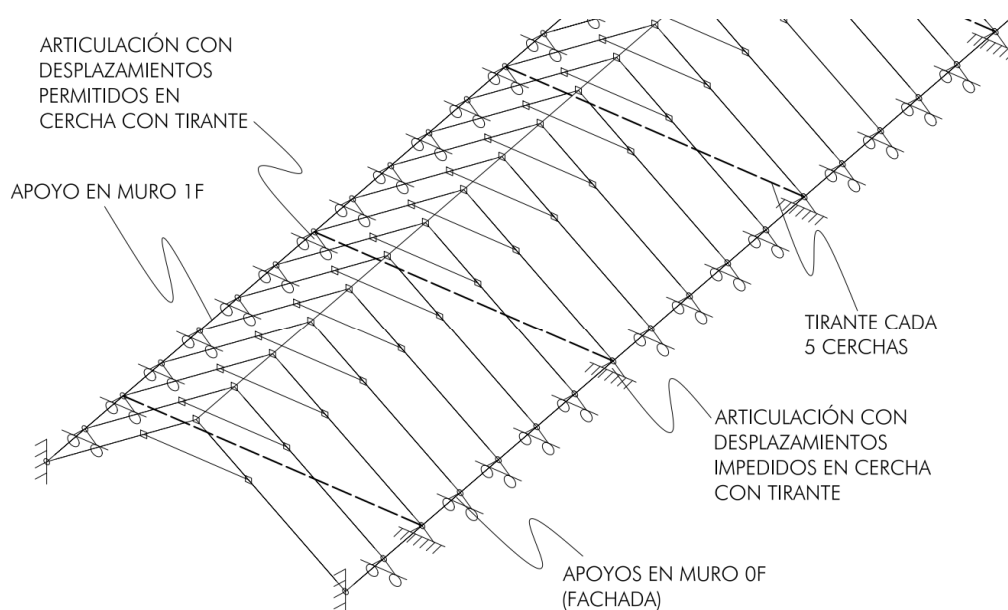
Modelo tridimensional de la estructura de planta de cubiertas
